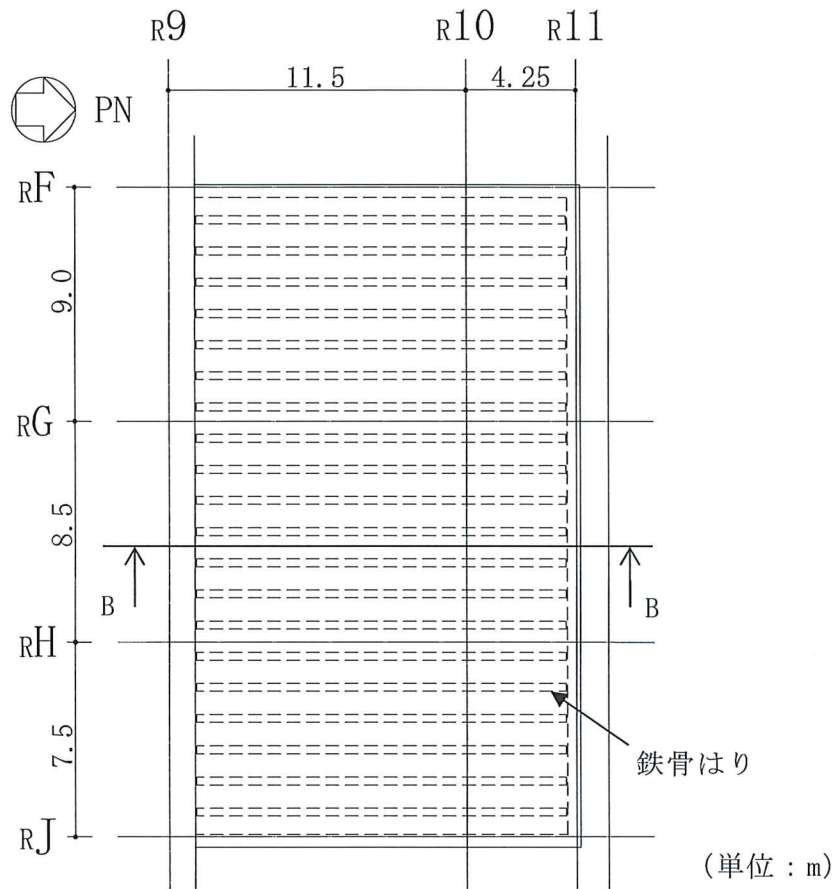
緊急時対策所（待機場所）屋根スラブの平面図
